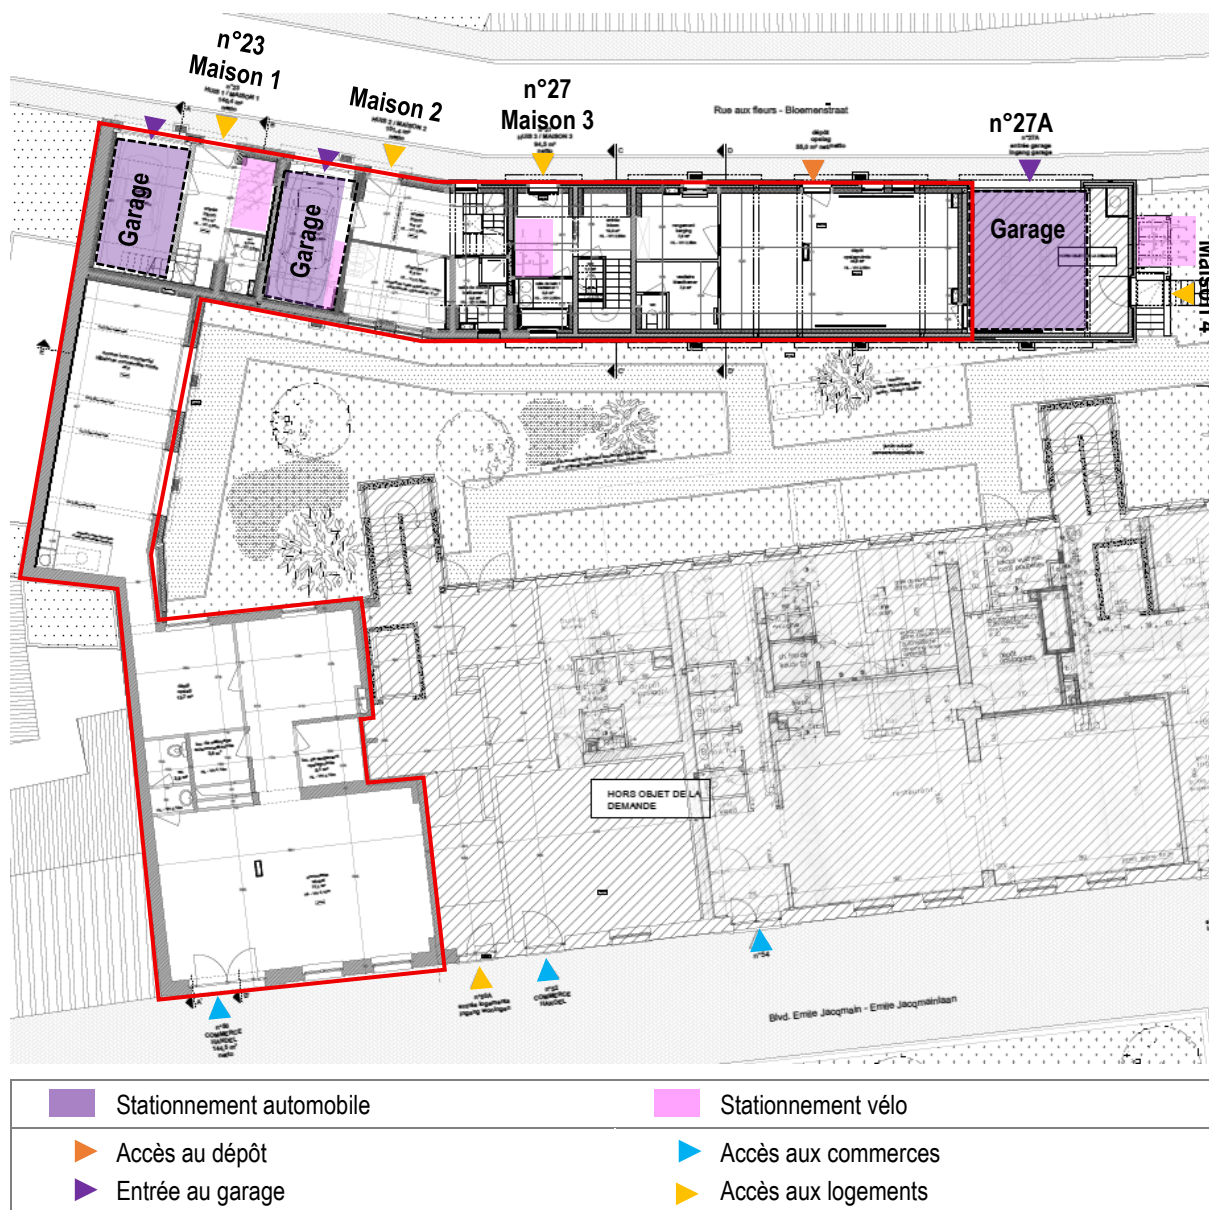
Localisation des accès aux bâtiments et zones de stationnement en situation projetée (ARIES sur fond Ville de Bruxelles, 2025)
